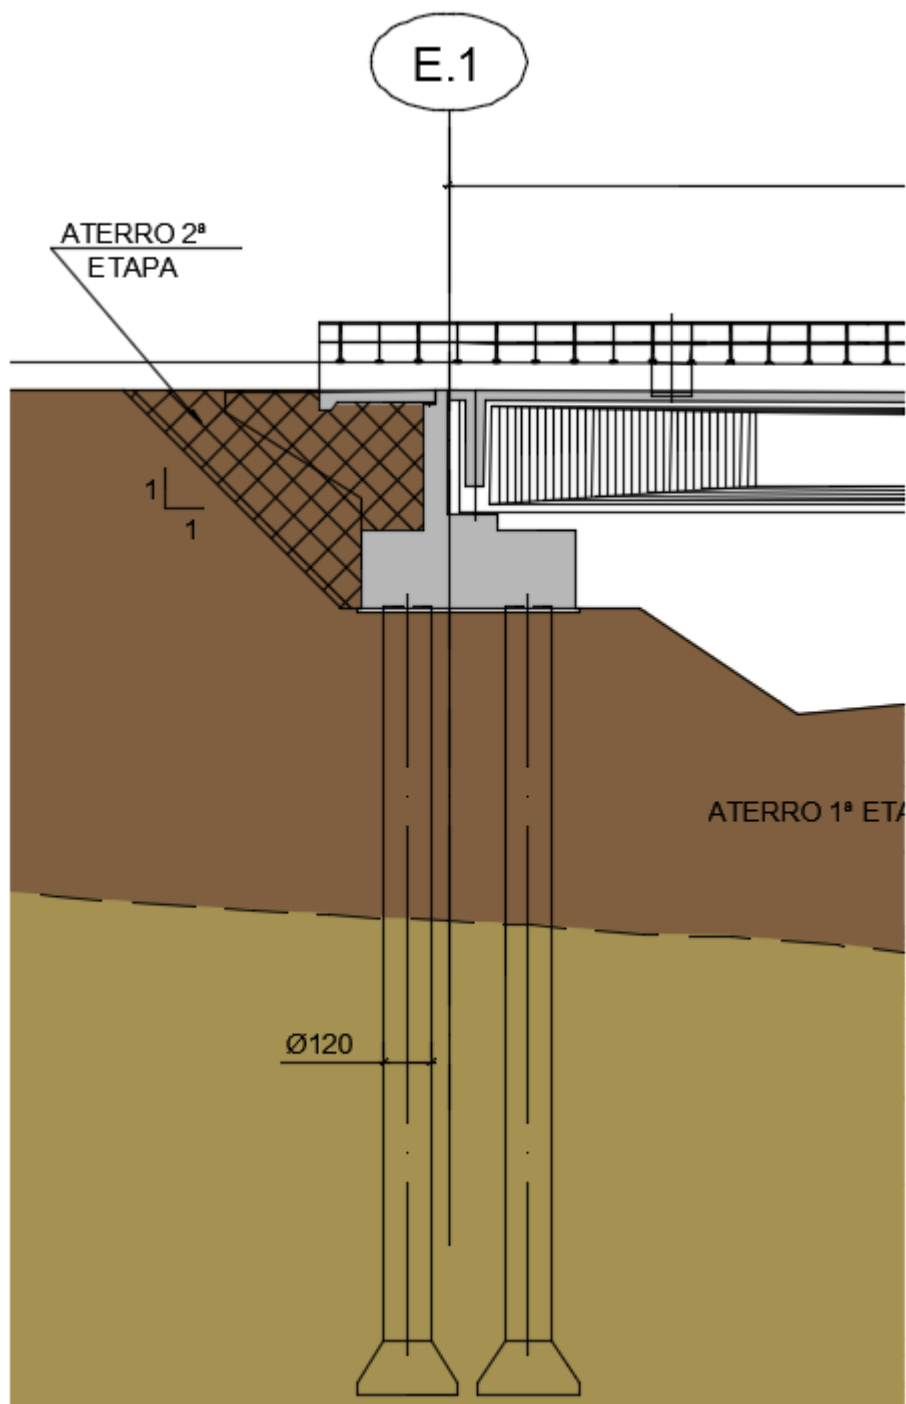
Elevação típica de um encontro com fundação por tubulões
